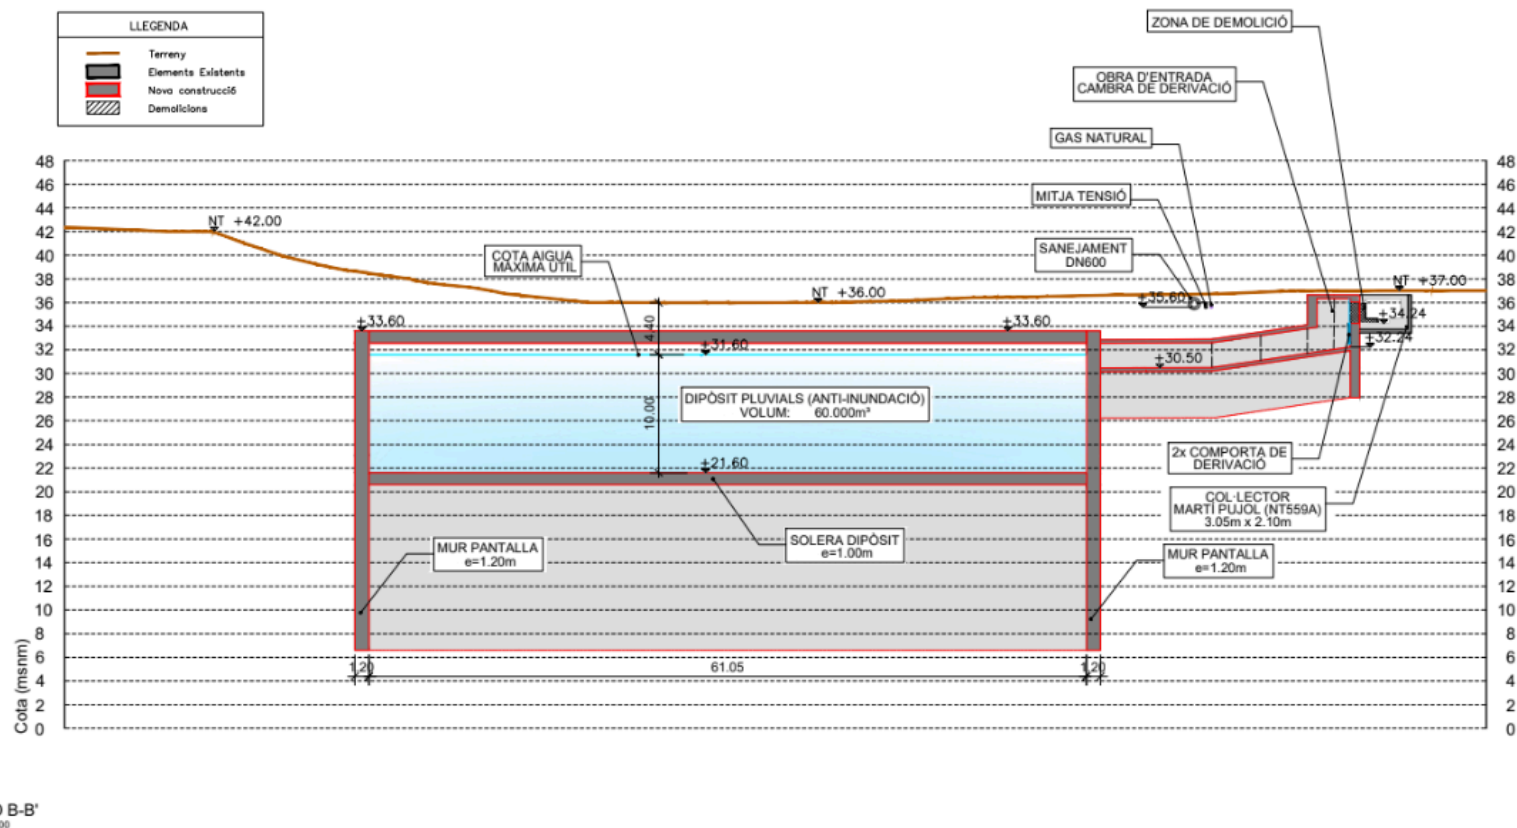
Sección longitudinal del nuevo depósito propuesto.
